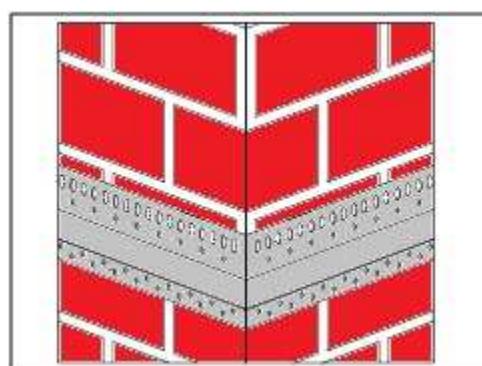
Založení zakládací lišty (varianta bez zateplení soklu)
